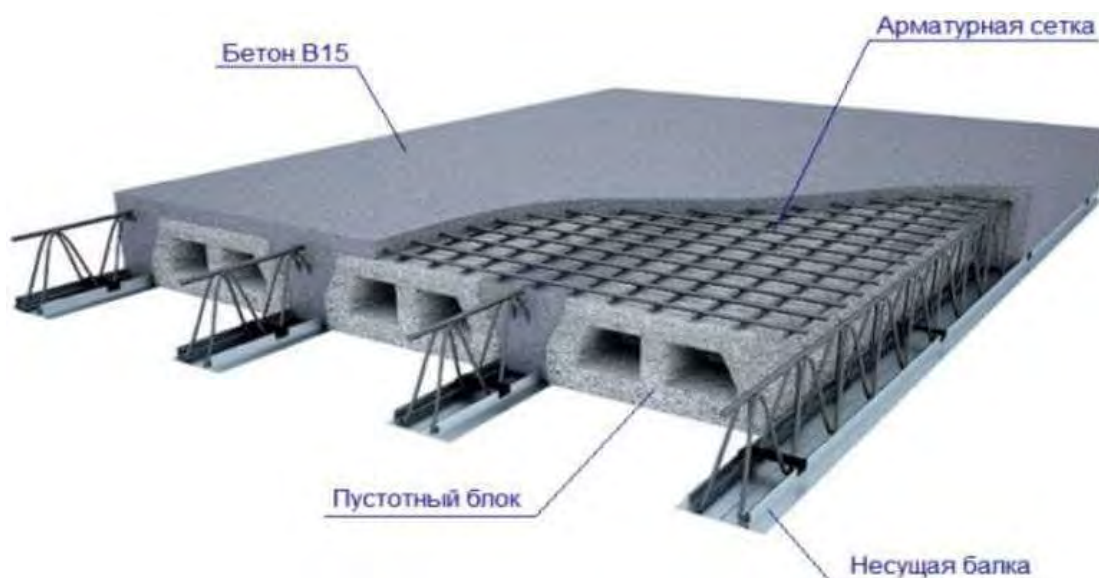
Конструкція монолітного залізобетонного перекриття
